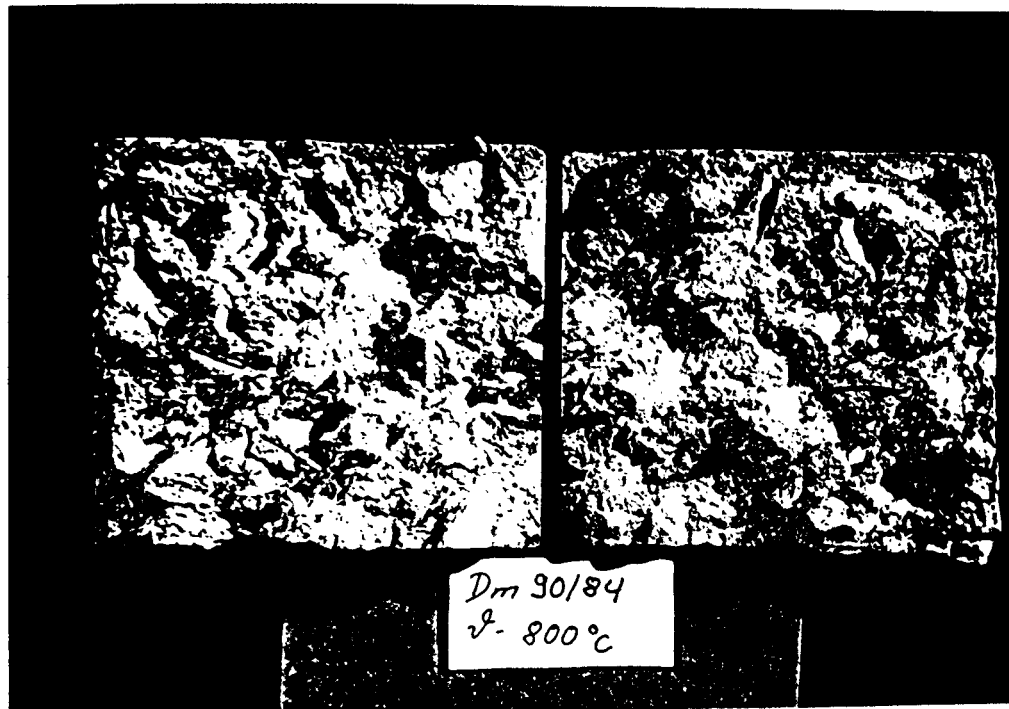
Bruchfläche eines bei 800 °C geprüften, stahlfaserbewehrten Diabasbetonprobekörpers
